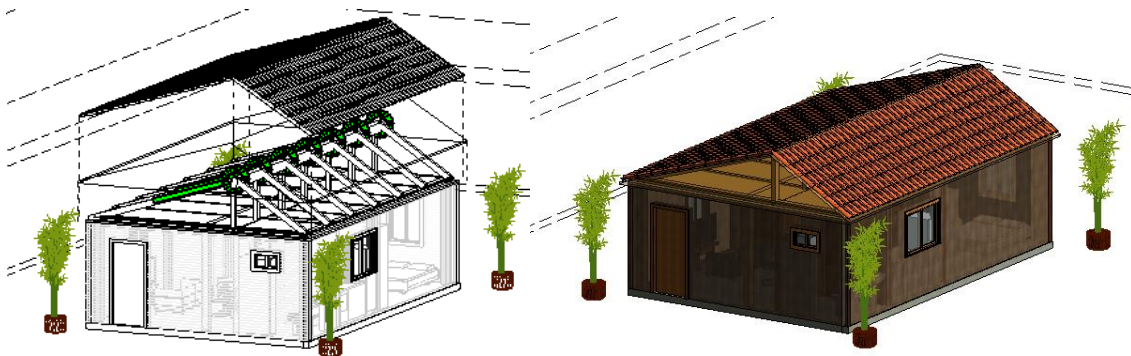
Vista en 3D de distribución estructural y arquitectura para vivienda autosustentable, Elaboración propia (2021)
